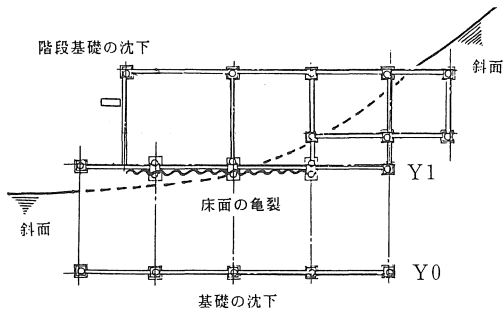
基礎、基礎梁と床面亀裂の発生状況
